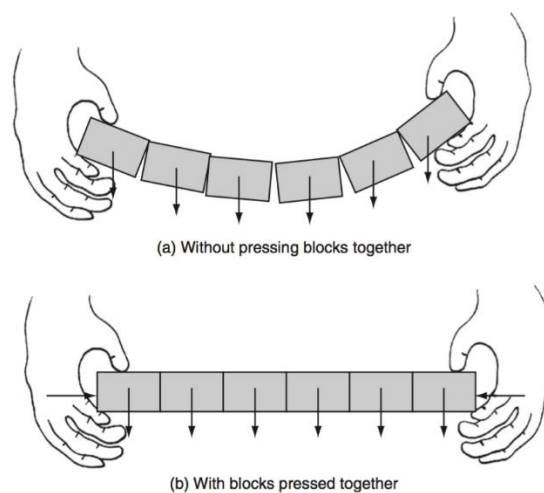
Pré-esforço aplicado em blocos de construção [3]
